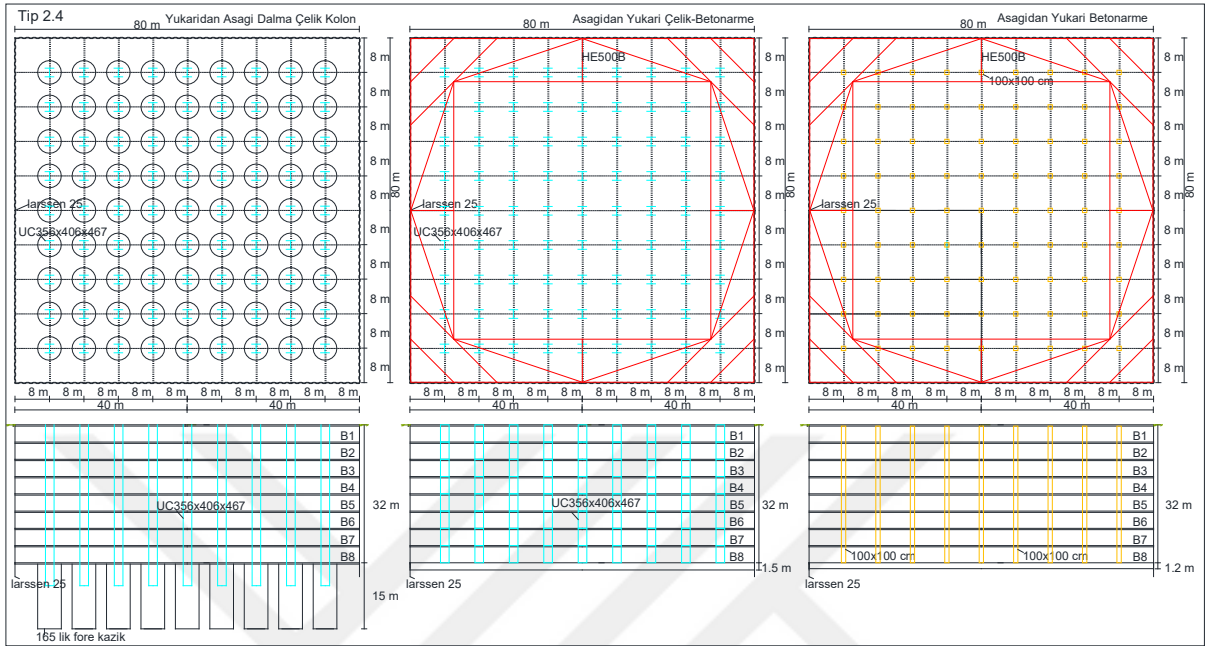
Tip 1.4'ün plan ve kesit görünüşleri
